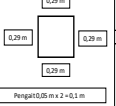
Detail Penulangan Kolom Tipe 2
